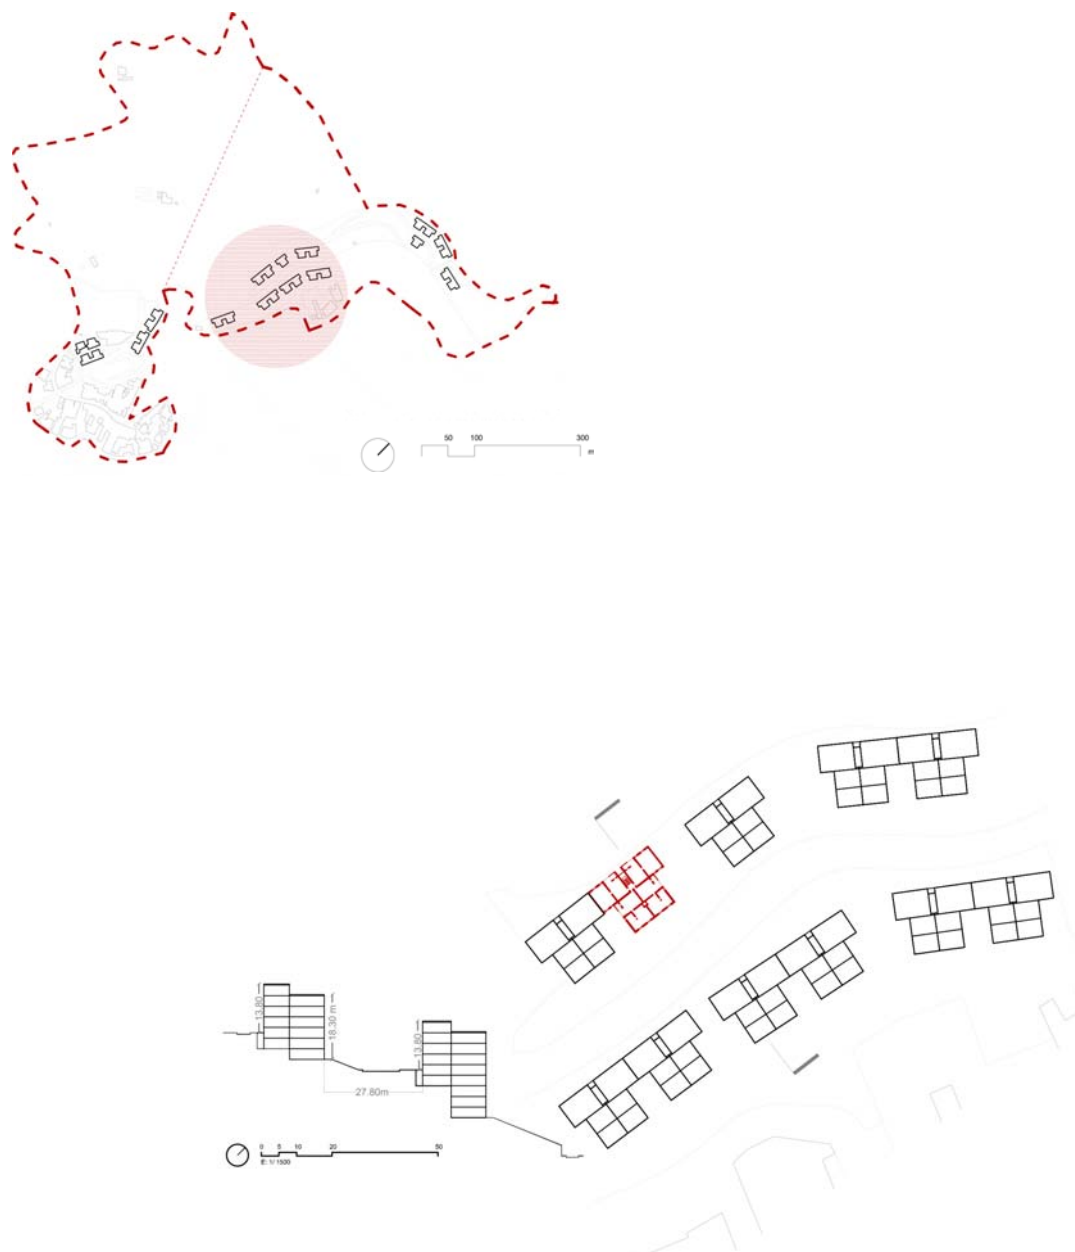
Plànol d'emplaçament i descripció tipològica en planta i secció d'un sector. Can Franquesa.
